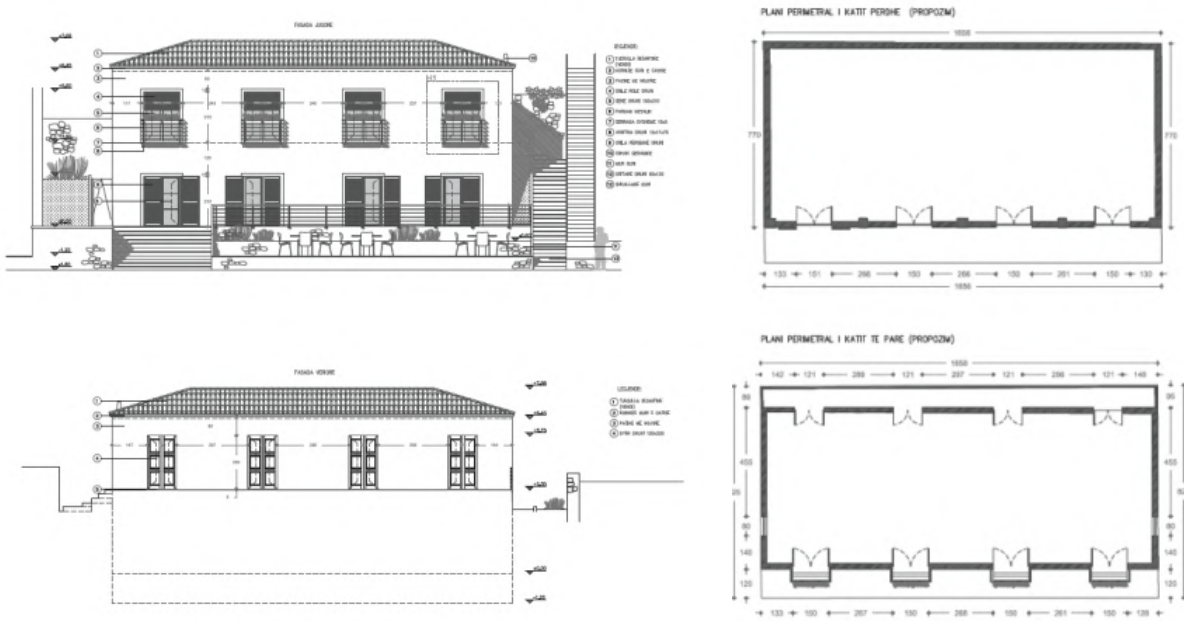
Ansichten und Grundriss des verwendeten Beispielgebäudes
